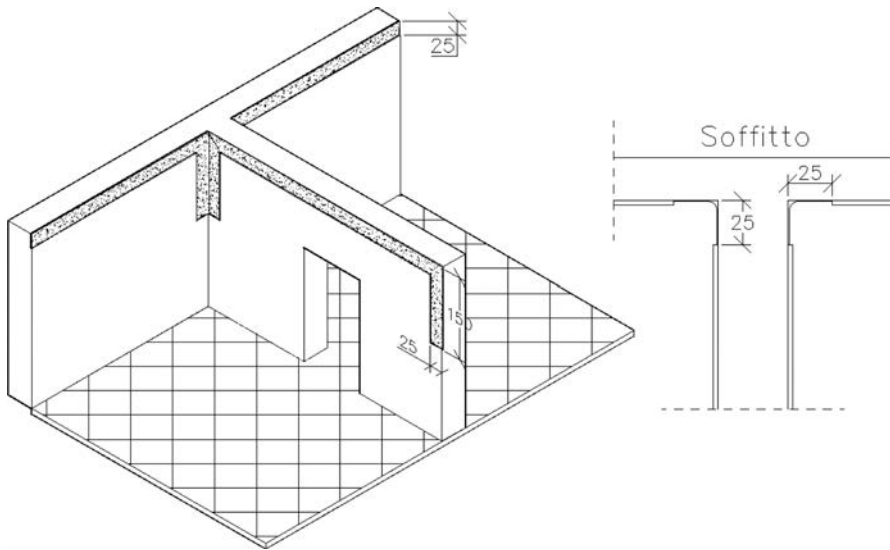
Applicazione di primo strato di malta cementizia bicomponente ad elevata duttilità.
